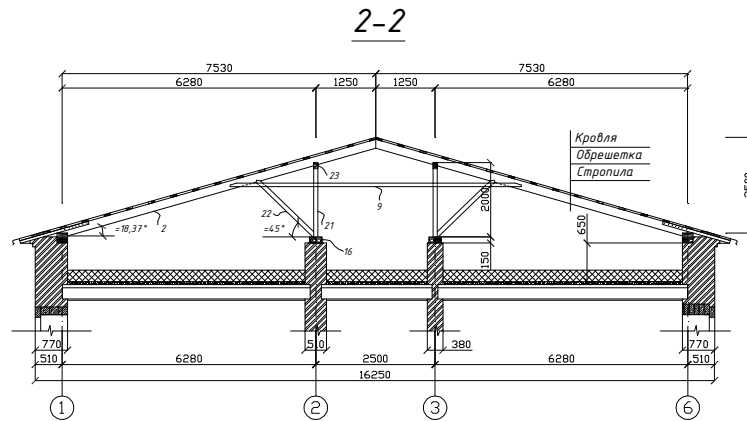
Поперечний розріз даху будівлі на ділянці в осях 1-6.
